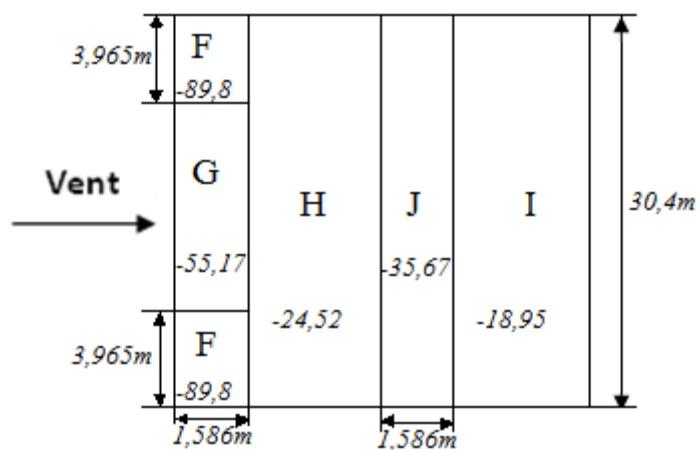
Pression statique du vent q_j sur la toiture (vent sur long pan1)
